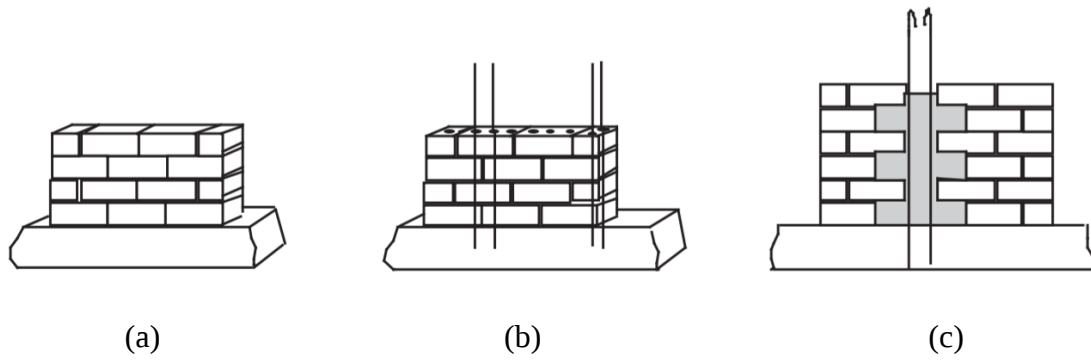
Tipos de albañilería (a) Simple (b) Armada (c) Confinada. Procesos y Técnicas de Construcción fuente: (Hernan & Guillermo, 2011)
